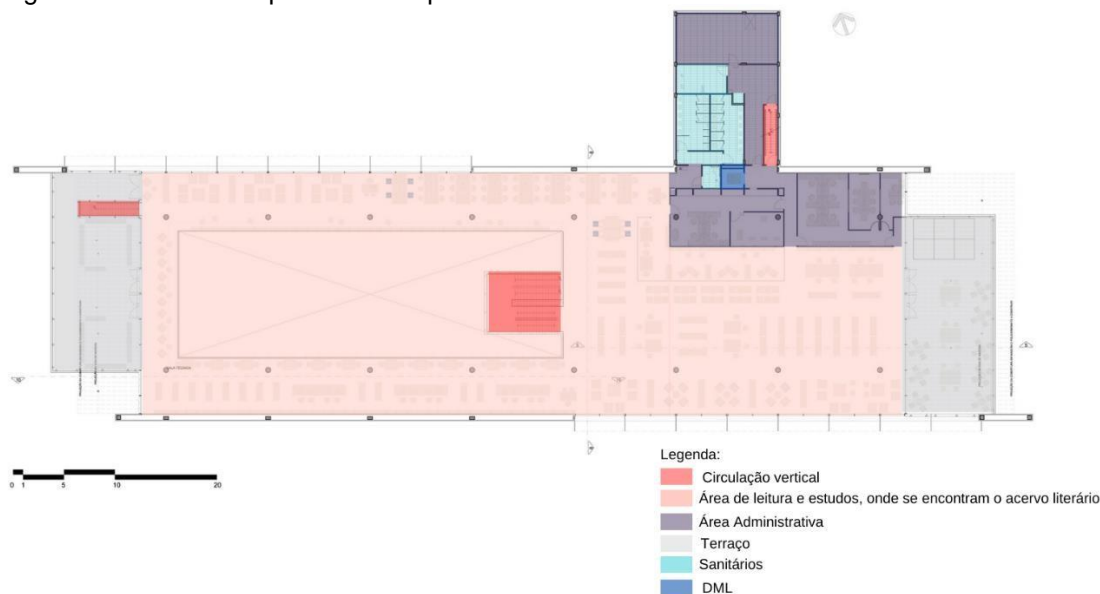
Planta baixa piso térreo da Biblioteca de São Paulo
